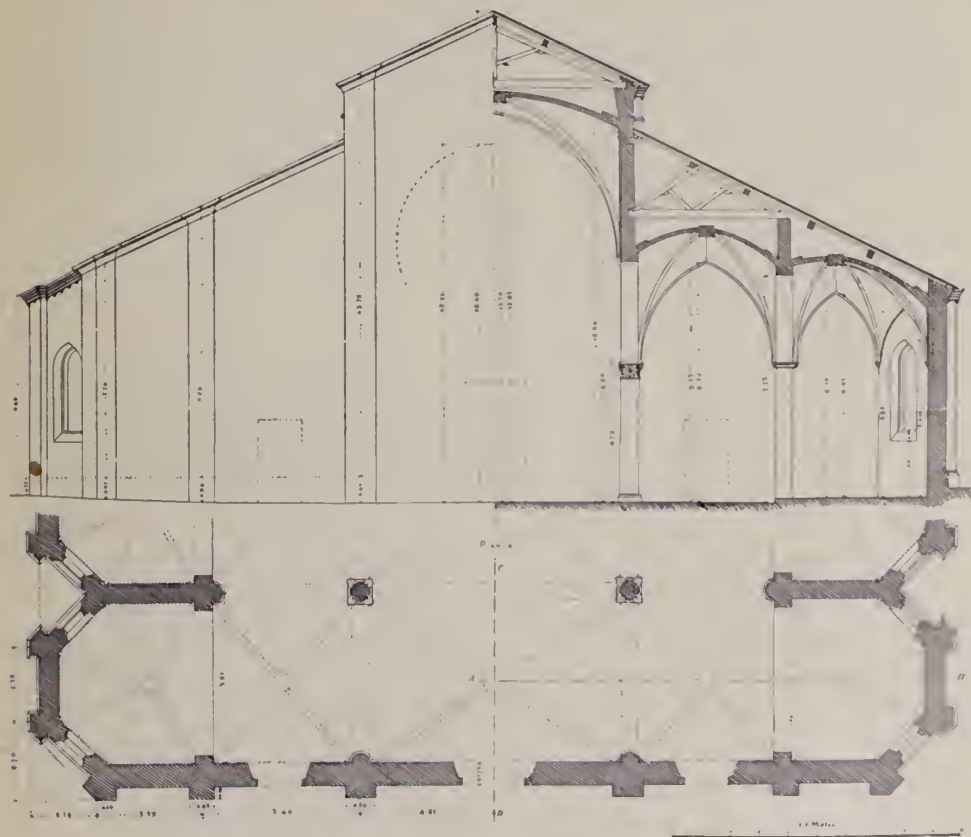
Milano, alzato e pianta di S. Pietro in Gessate.
